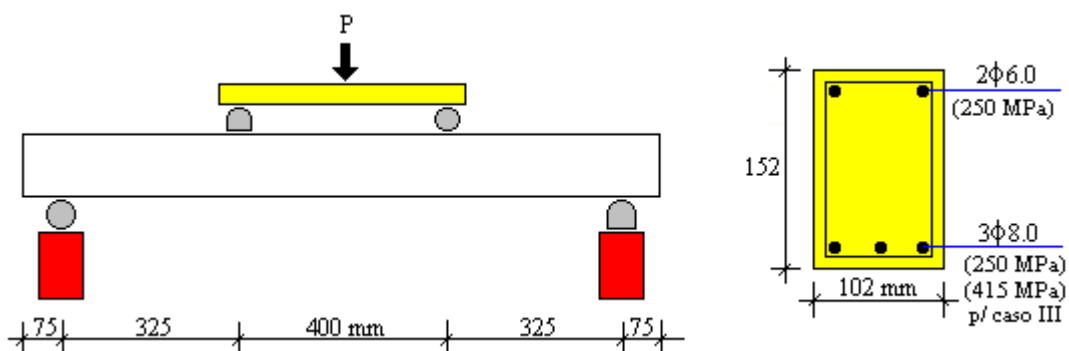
Vigas Originais - Seção Transversal Típica e Esquema do Ensaio
